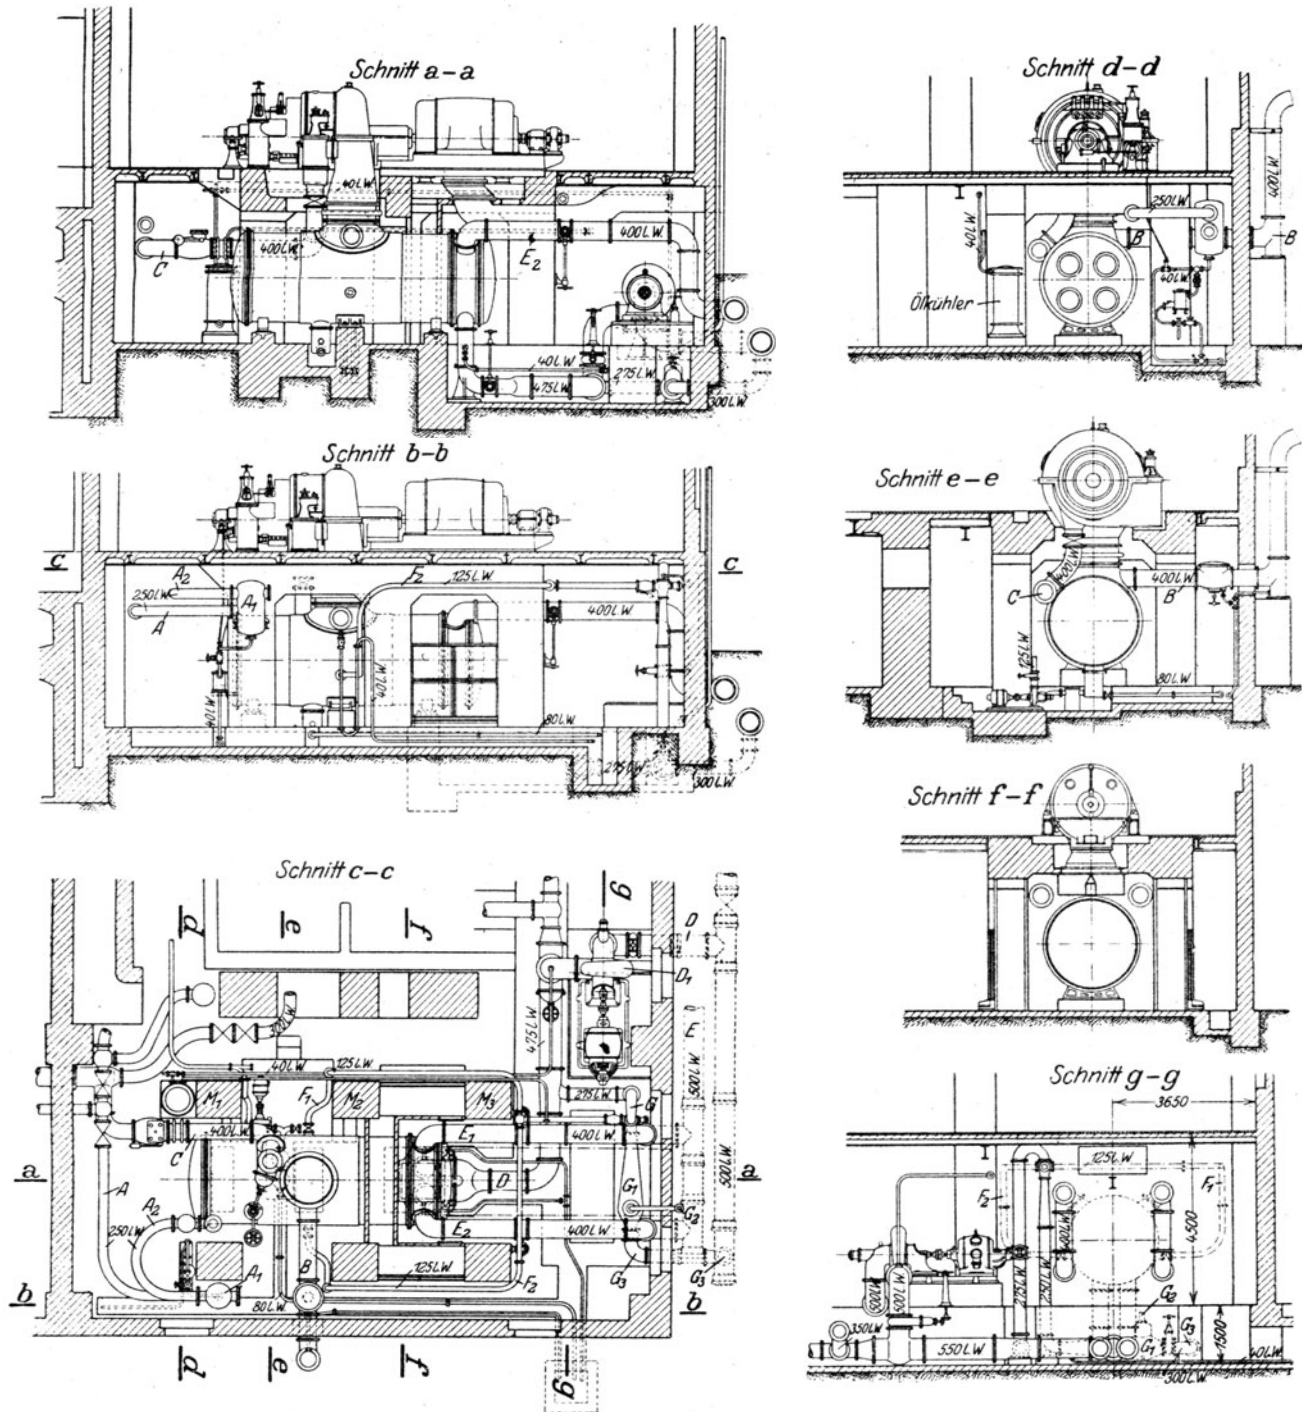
Fundament und Rohrleitungsplan einer 5200 PS-Anlage der Maschinenfabrik Augsburg-Nürnberg.
